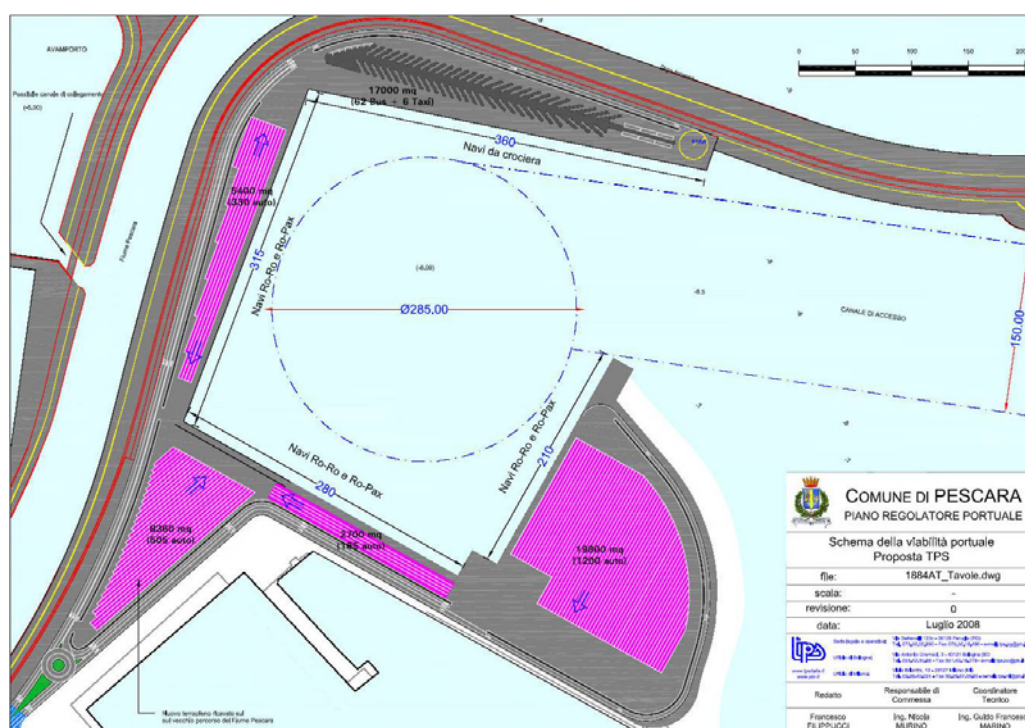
Planimetria del progetto TPS sulla viabilità interna al nuovo porto.
